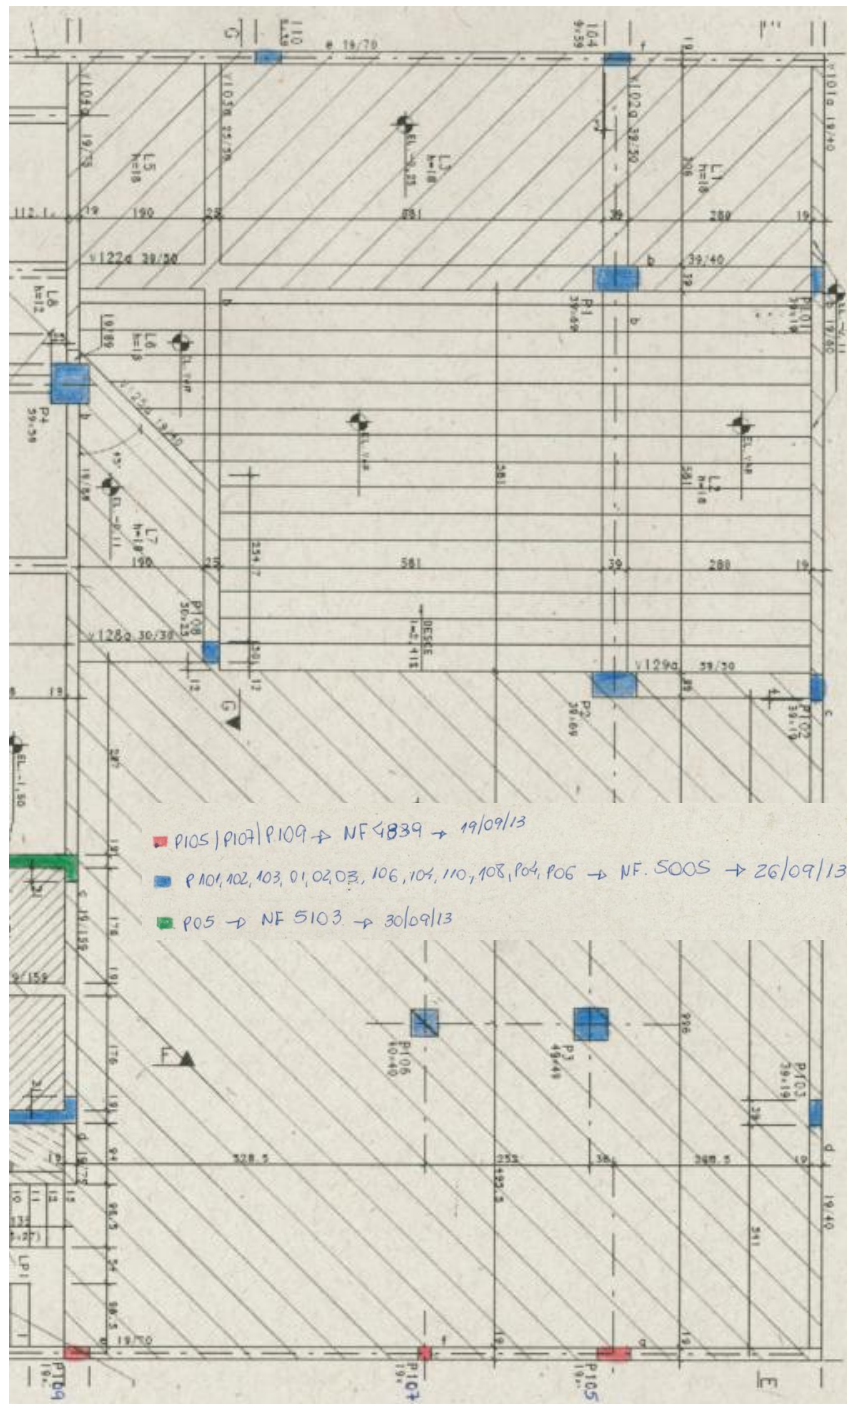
7 - Pilares entre 1º e 2º pavimento
